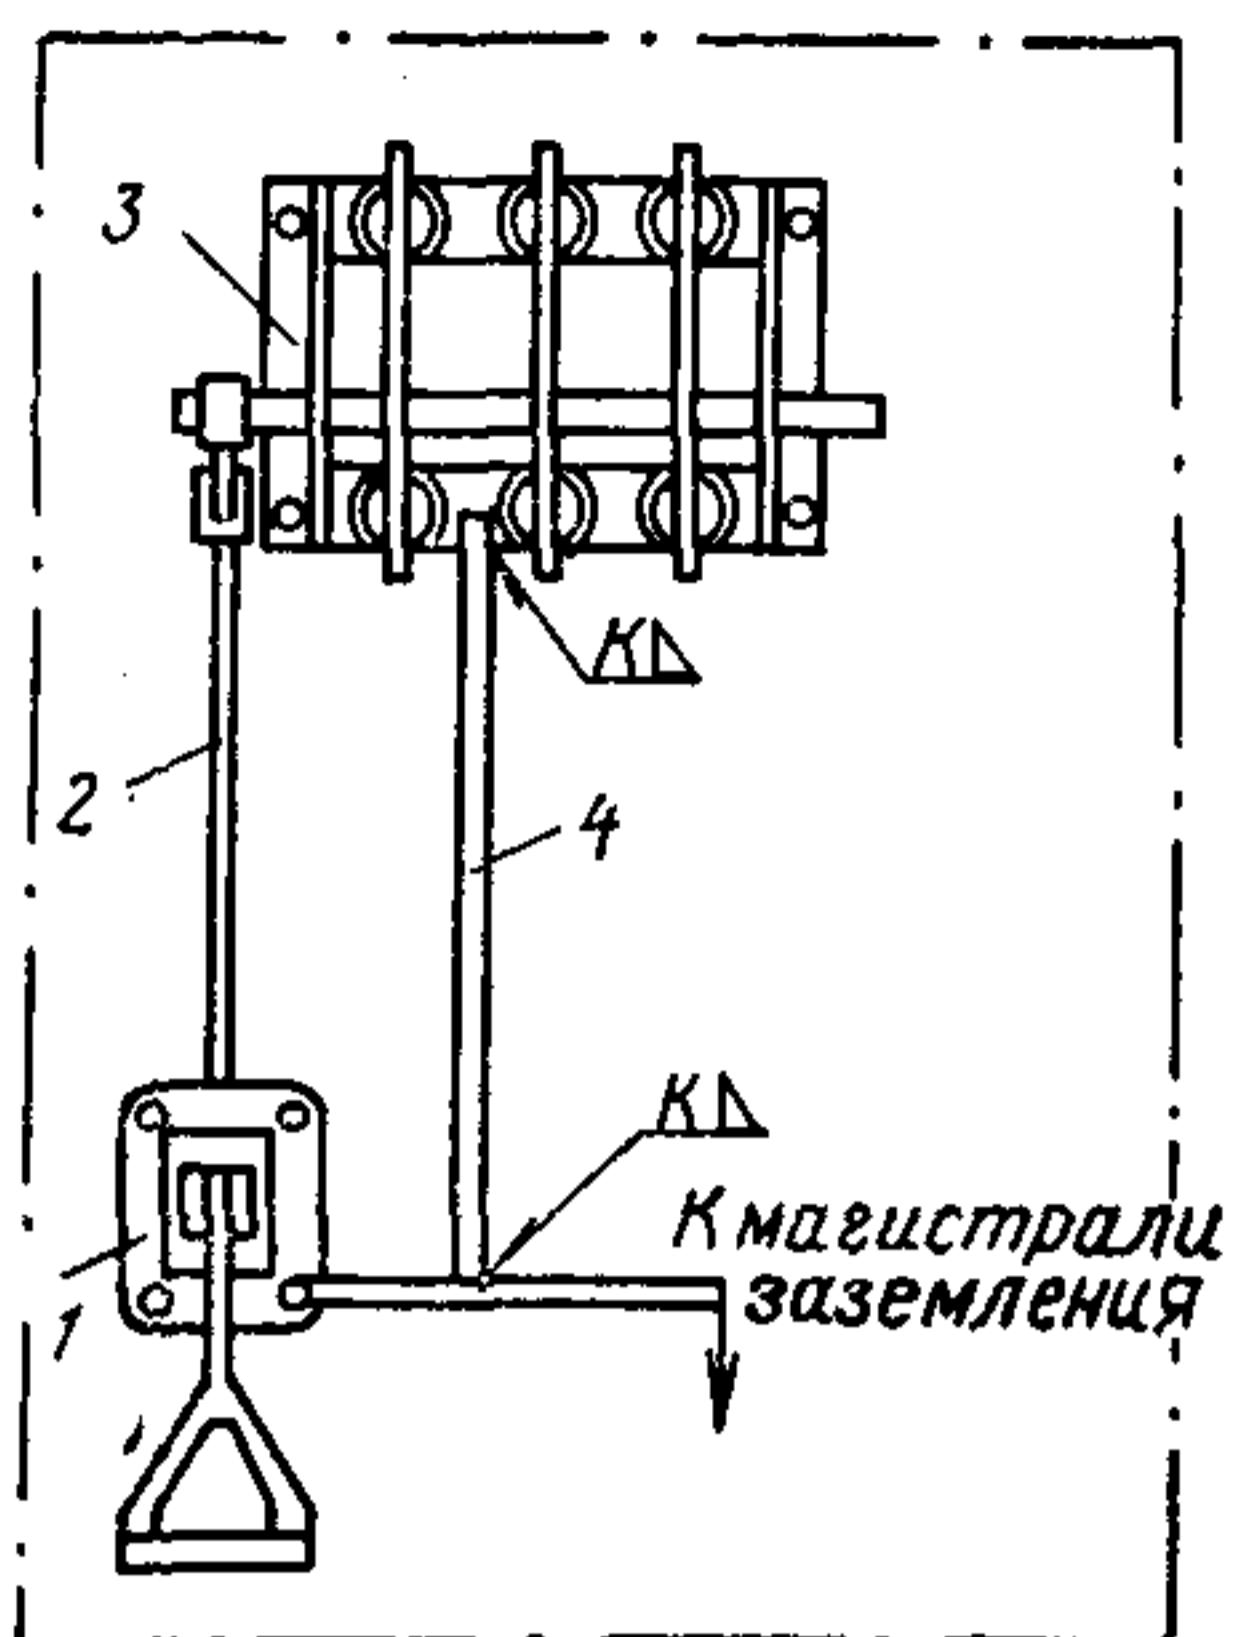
Заземление рамы и привода трехполюсного разъединителя
